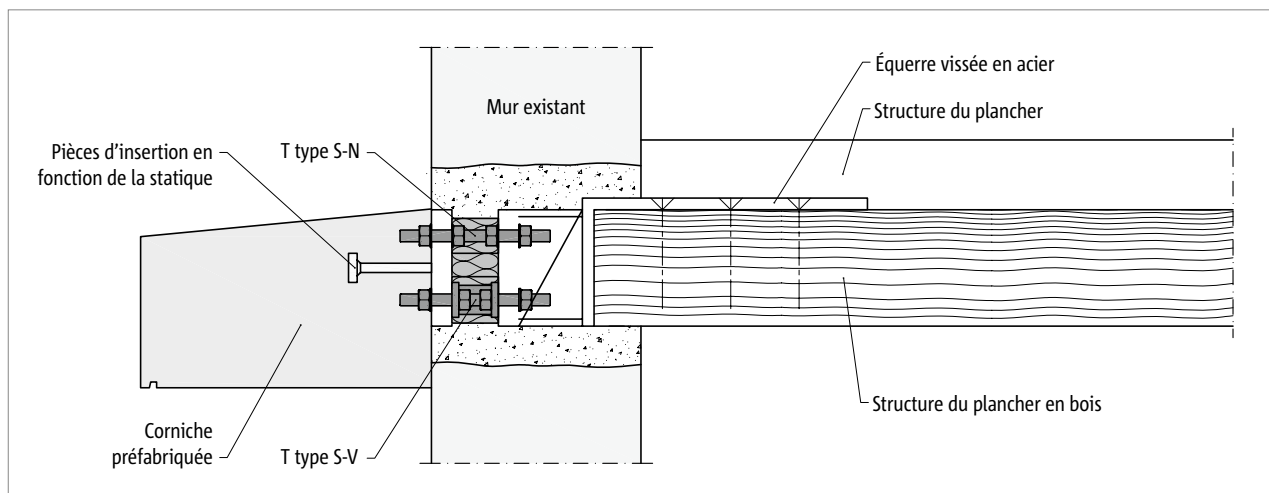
Schöck Isokorb® T type S-N et T type S-V : élément préfabriqué posé ultérieurement (corniche) en porte-à-faux ; raccordé à une structure existante de plancher en bois
